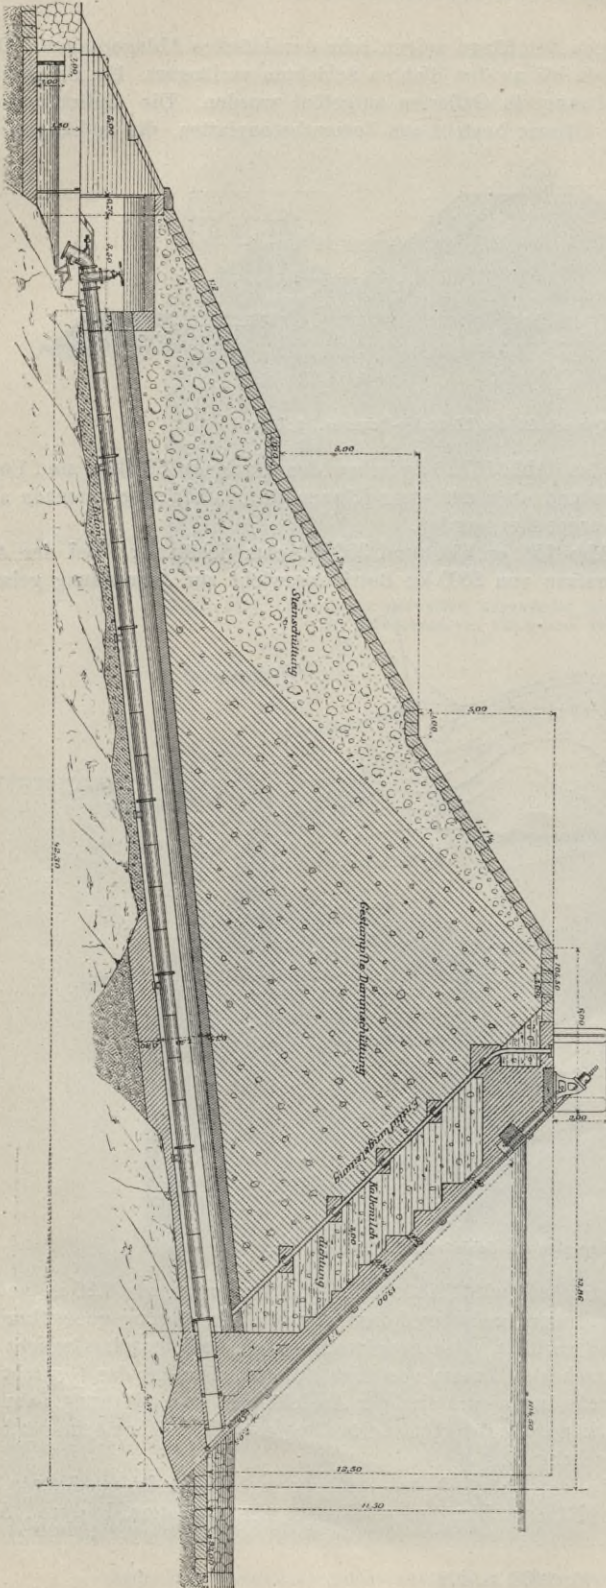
Querschnitt des Schießrothried Dammes. Ungerf. Maßstab 1:300.
